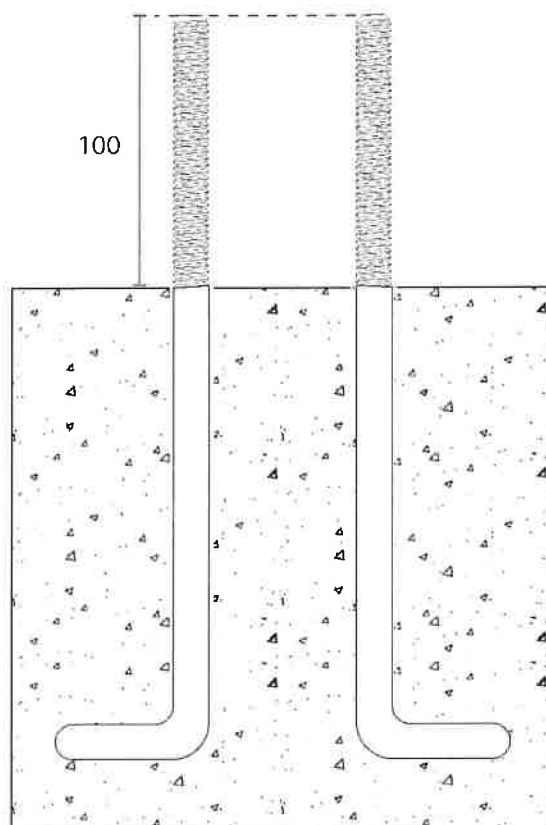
Montagem das hastes de fixação em maciço de betão.
